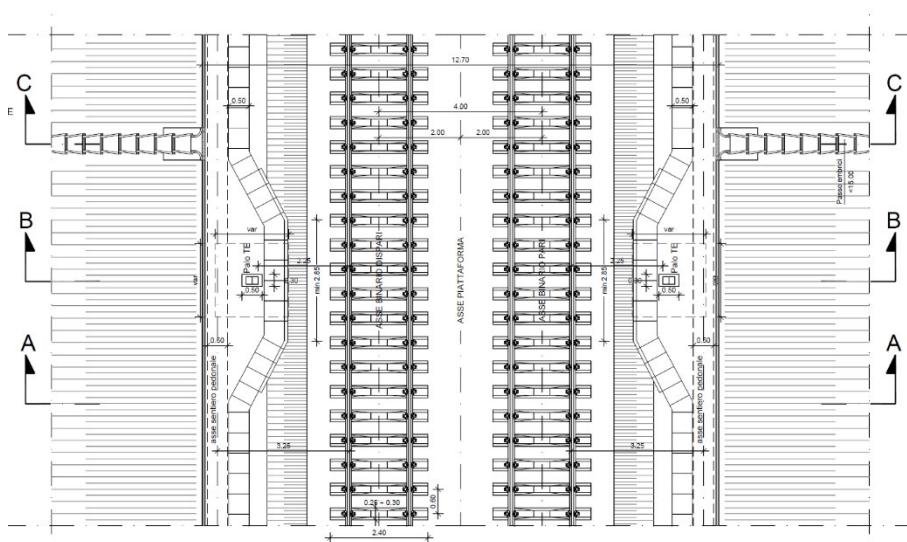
Stralcio planimetrico con sezione tipo ferroviaria in rilevato a doppio binario in rettilineo
